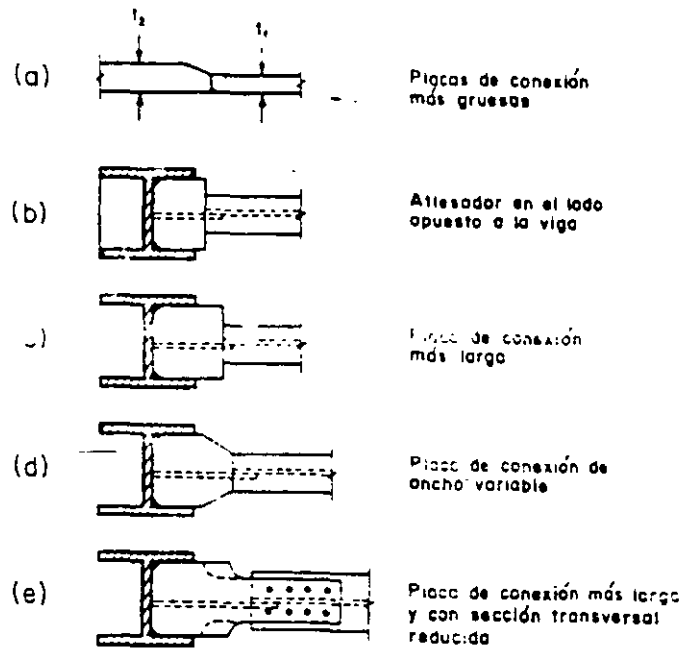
Medidas para mejorar el comportamiento de juntas con Vigas unidas al alma de la columna .
